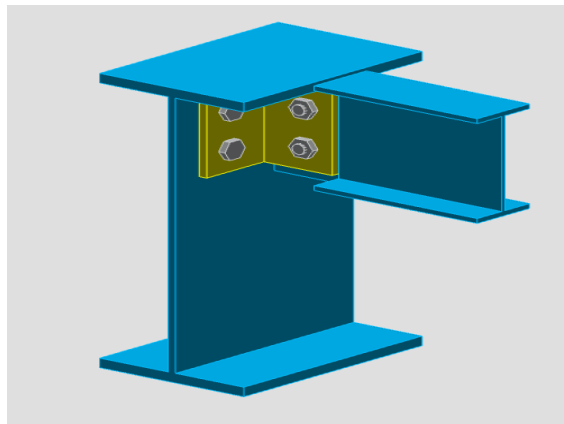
Schéma d'assemblages solive-poutre principale 3D
